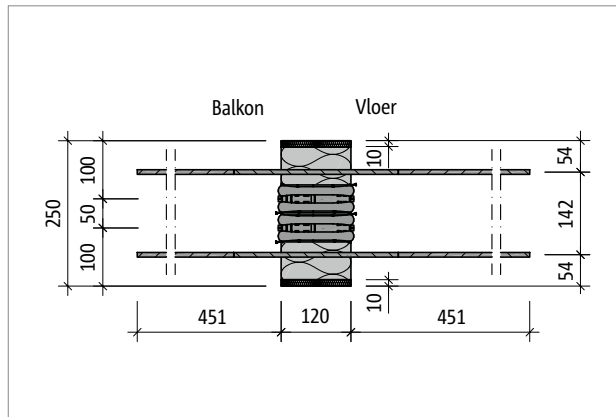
Schöck Isokorf® XT type Q-E-V3: Bovenaanzicht
